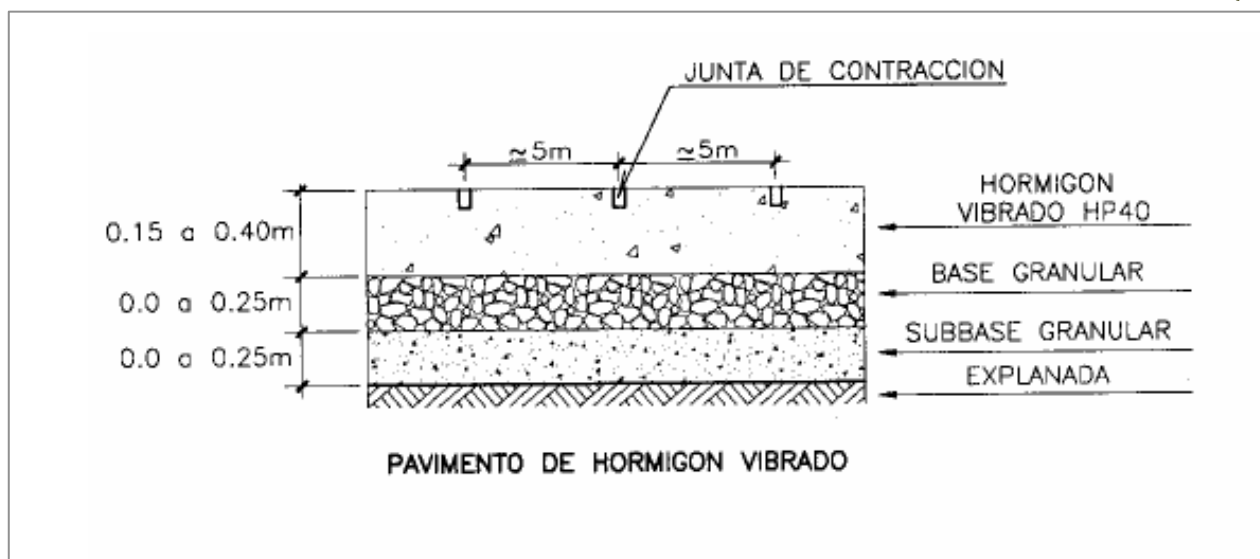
Pavimento de hormigón vibrado. Sección tipo
